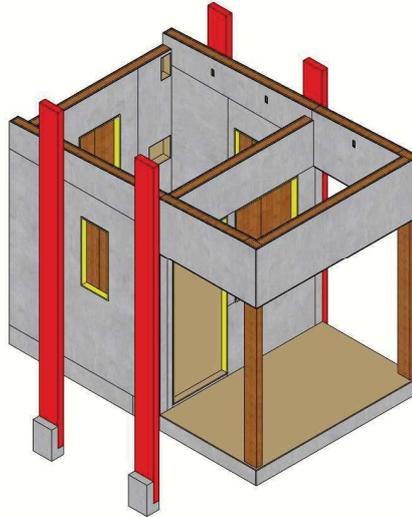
Fixação dos painéis parede (P5A e P5B).
